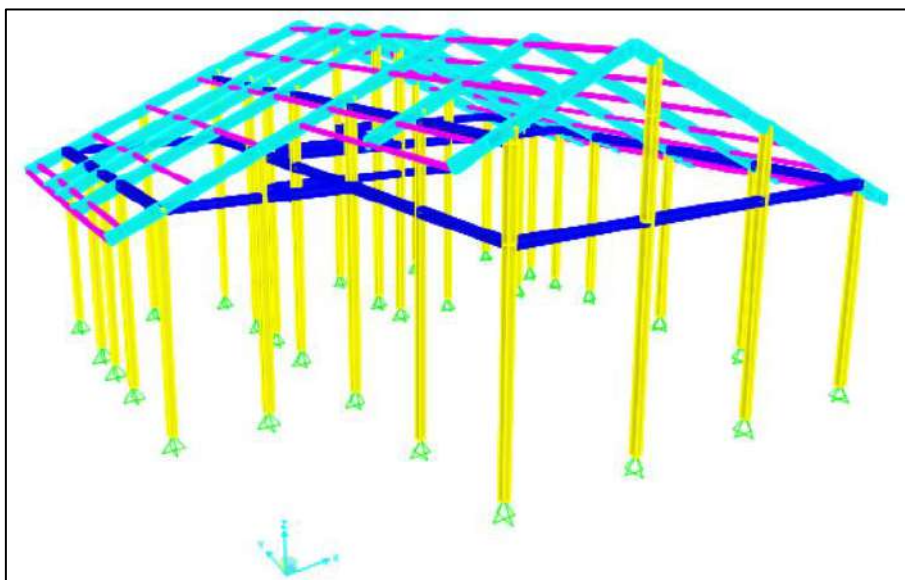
Labels de elementos tipo Frame, cobertura metálica.
